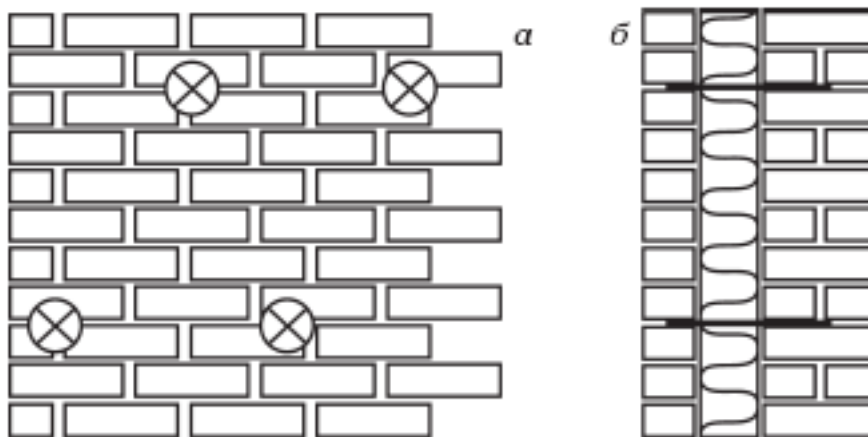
Установка связей между внутренней и наружной стенками в трехслойной стене: а) вид прямо; б) разрез
